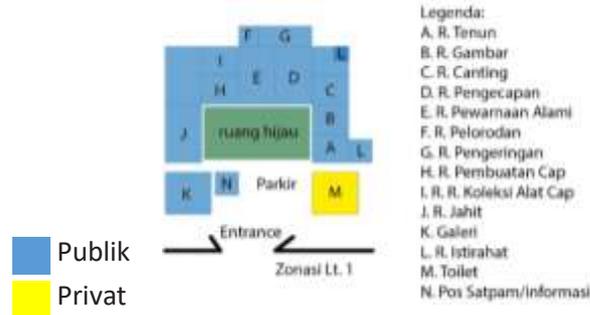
Ilustrasi Blockplan Sanggar Batik Semarang 16 dan Arah Sirkulasi Pengunjung
